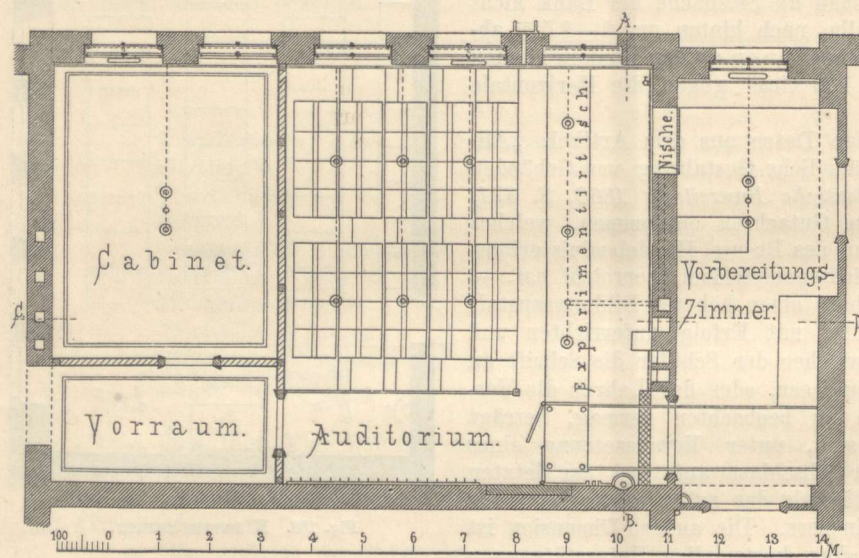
Grundriss des Auditoriums für Physik.
